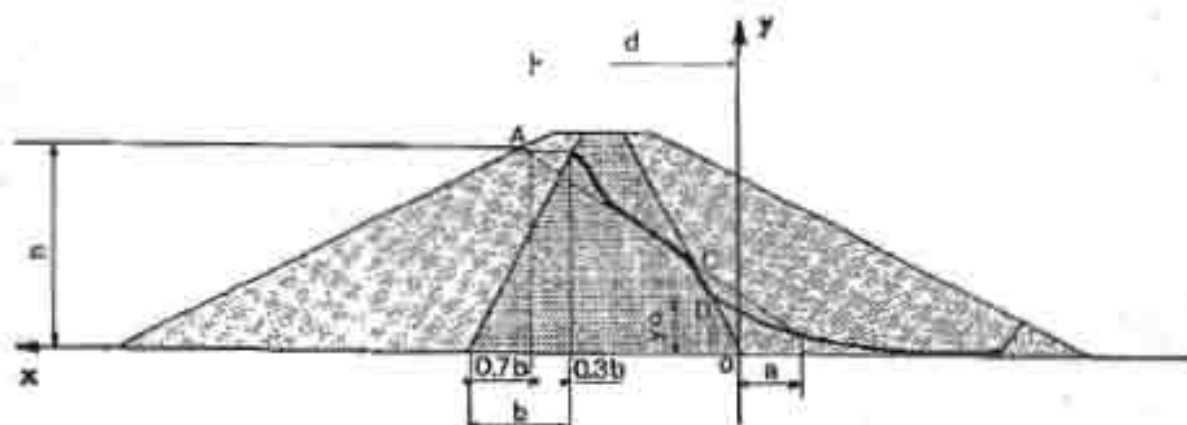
ligne de saturation dans le cas d'un barrage à zone
